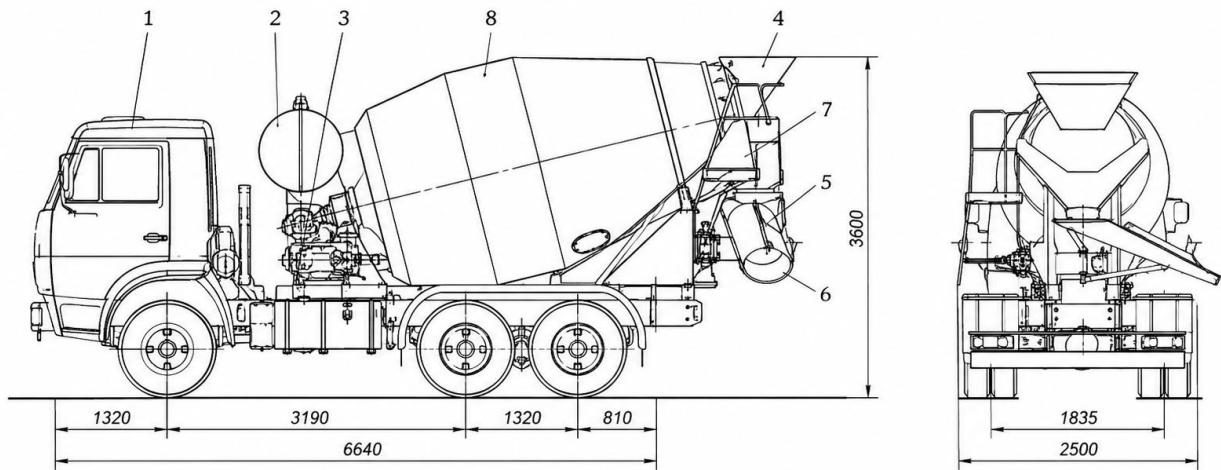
Автобетононасос СБ-126А: 1 — кабіна водія; 2 — бак для води; 3 — гідравлічний привід; 4 — завантажувальний бункер; 5 — розвантажувальний жолоб; 6 — трубопровід для подачі бетонної суміші; 7 — механізм нахилу розвантажувального жолоба; 8 — змішувальний барабан
